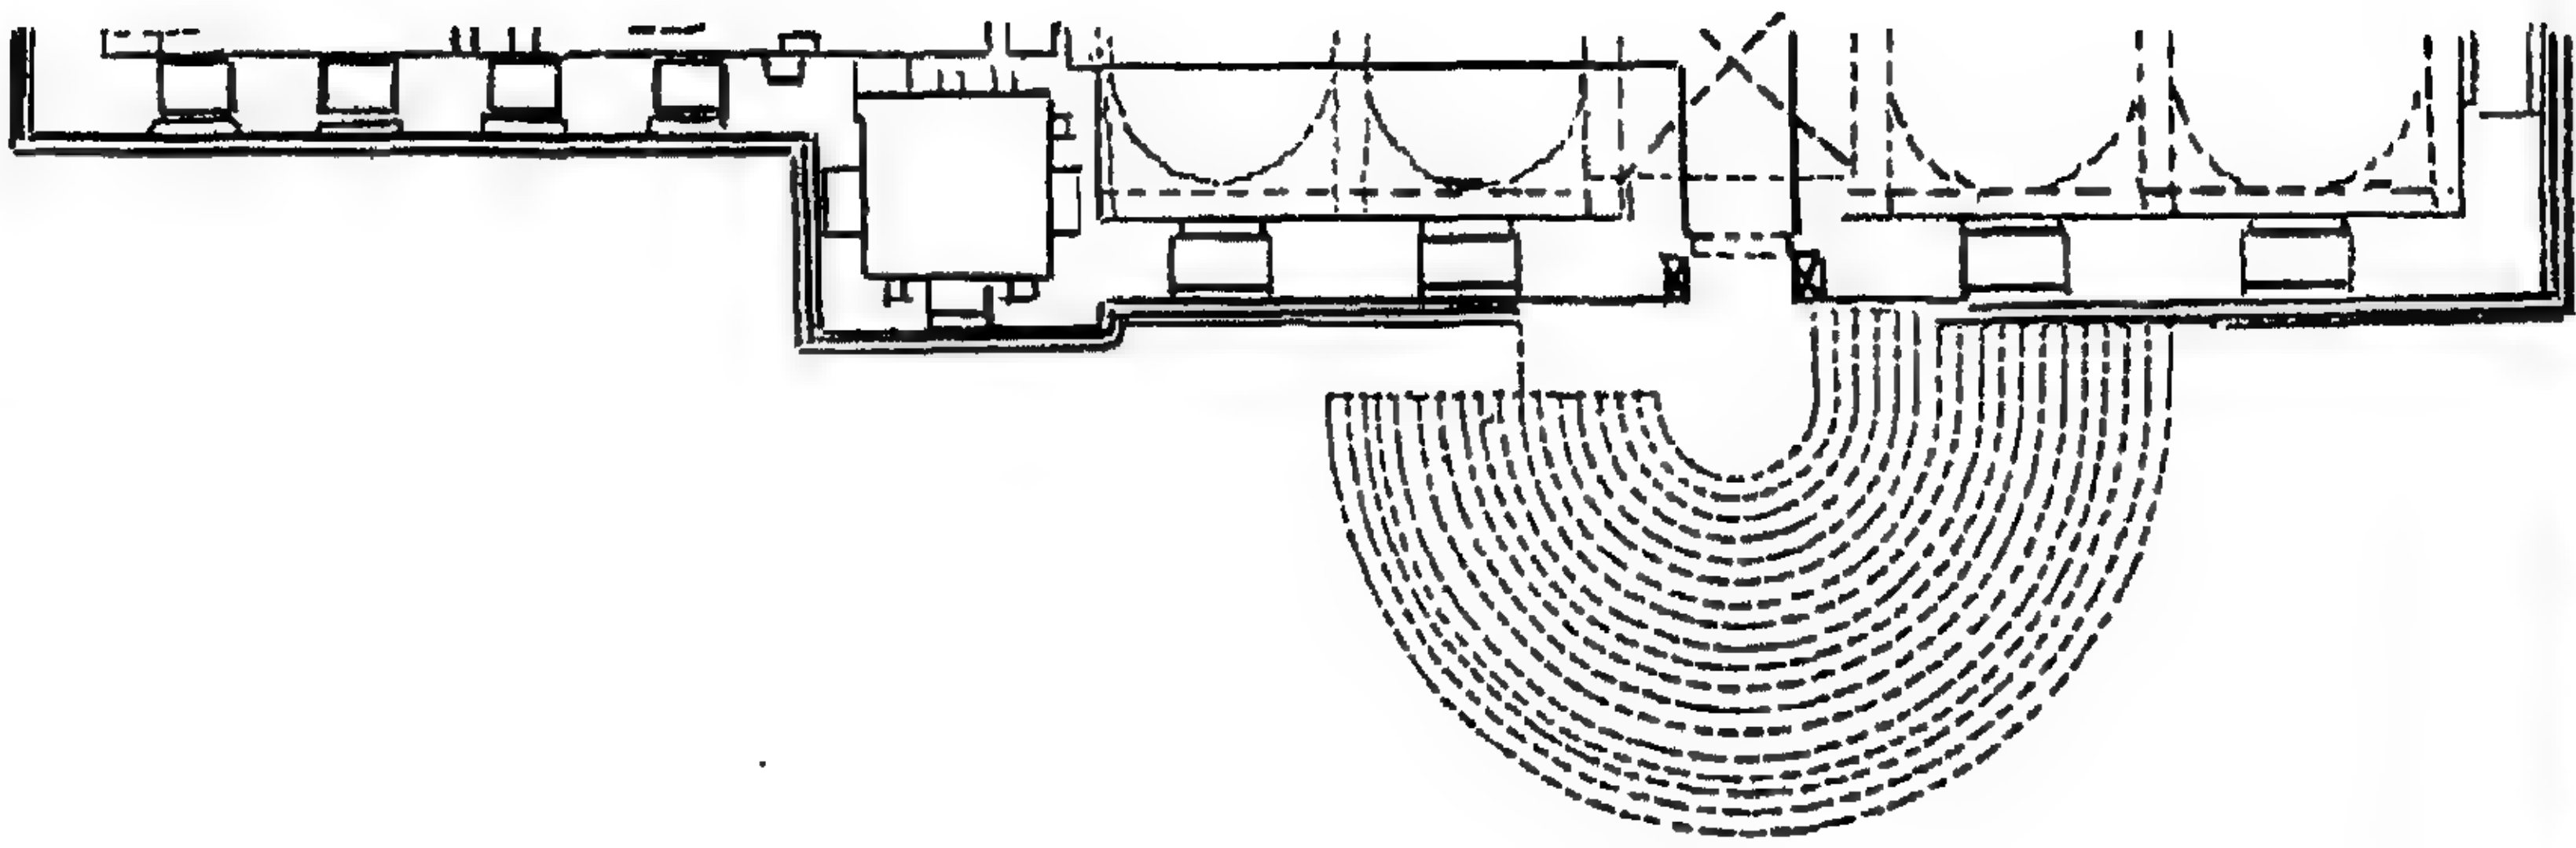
مسقط أفقى لجامع الملكة صفية.
